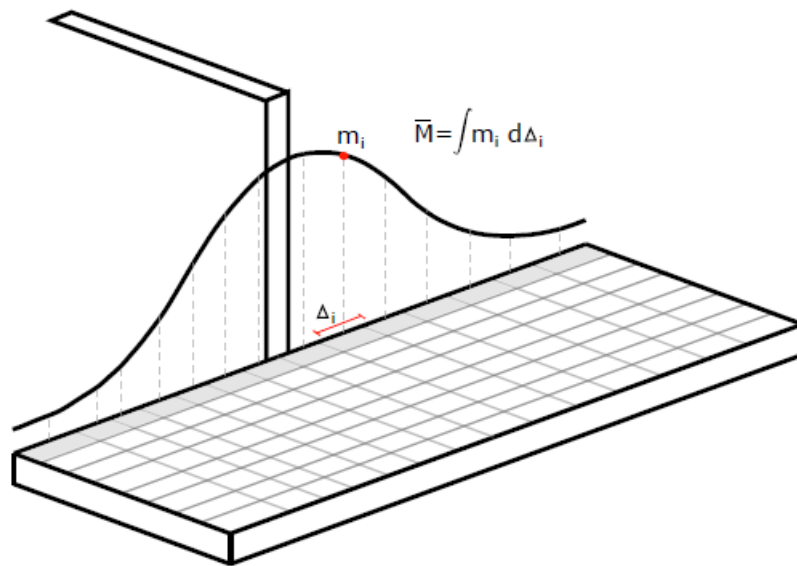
Distribución de Momento Transferido por la Losa hacia el Muro [1]
